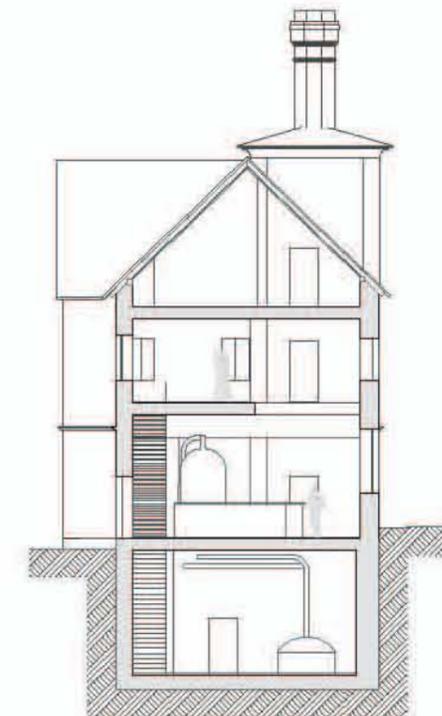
Schnitt E-E Restaurant (ehem. Sudhaus)
